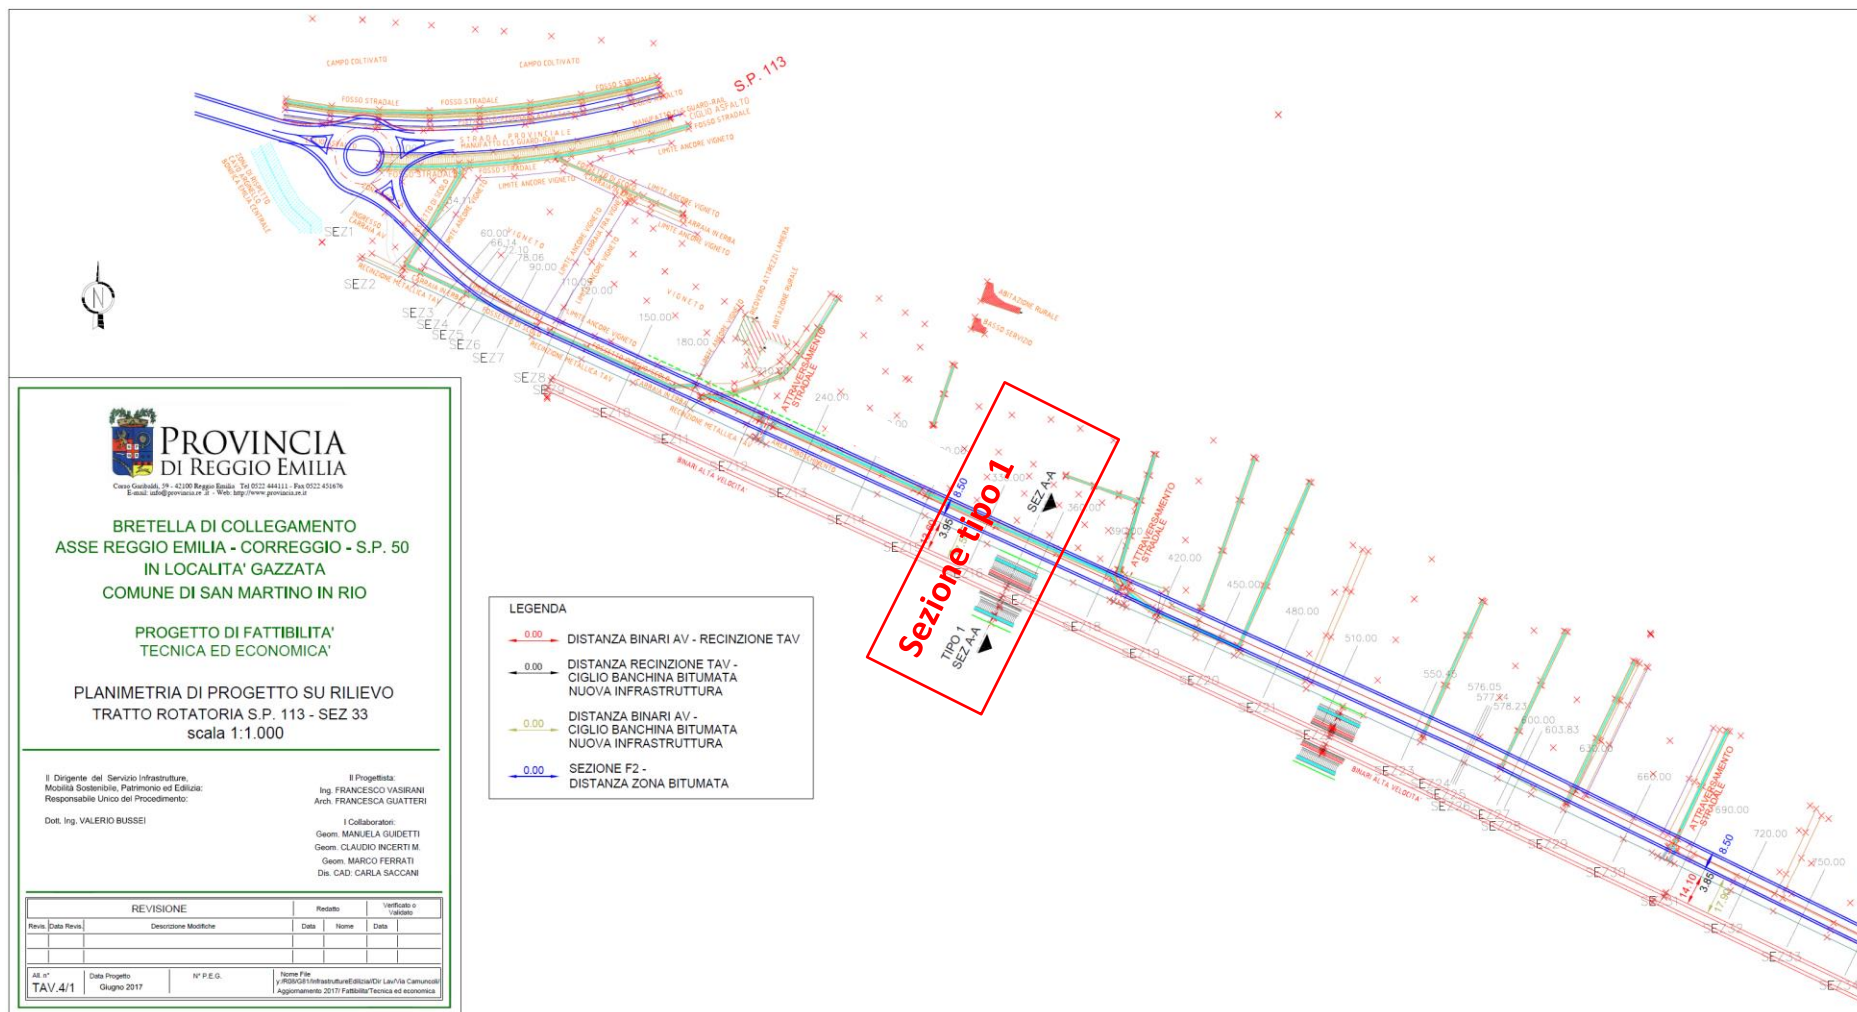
Planimetria di progetto su rilievo (seconda parte)
